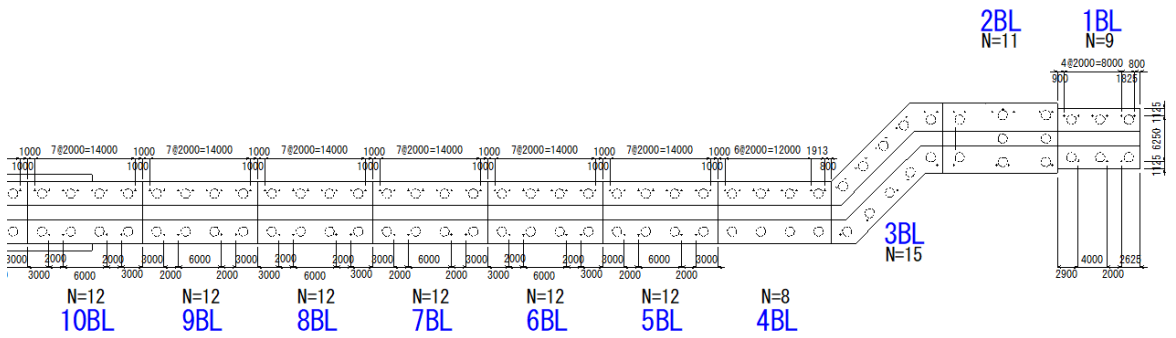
防波壁（逆 T 擁壁）の概略配筋図
